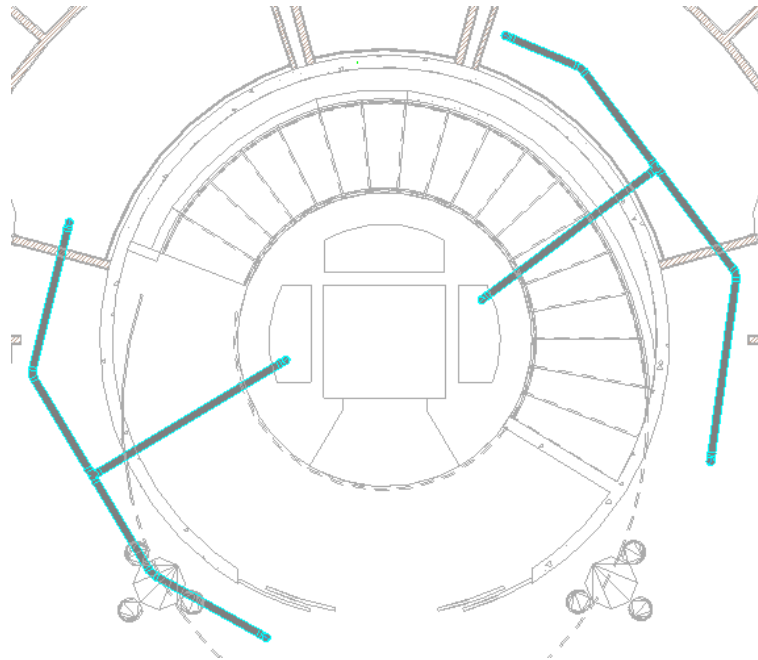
Instalación de desagüe de pluviales (Vista de planta Nivel Mirador)
